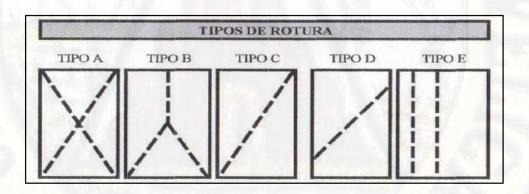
Esquema de los tipos de fallas por Ensayo a Compresión.
